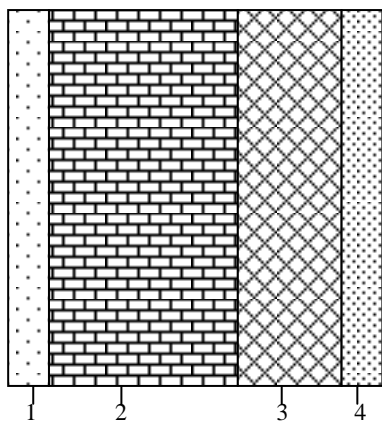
Схема конструкции наружной стены здания: 1 – штукатурный слой; 2 – кирпичная кладка; 3 – слой утеплителя из поробетона; 4 – облицовка затиркой
